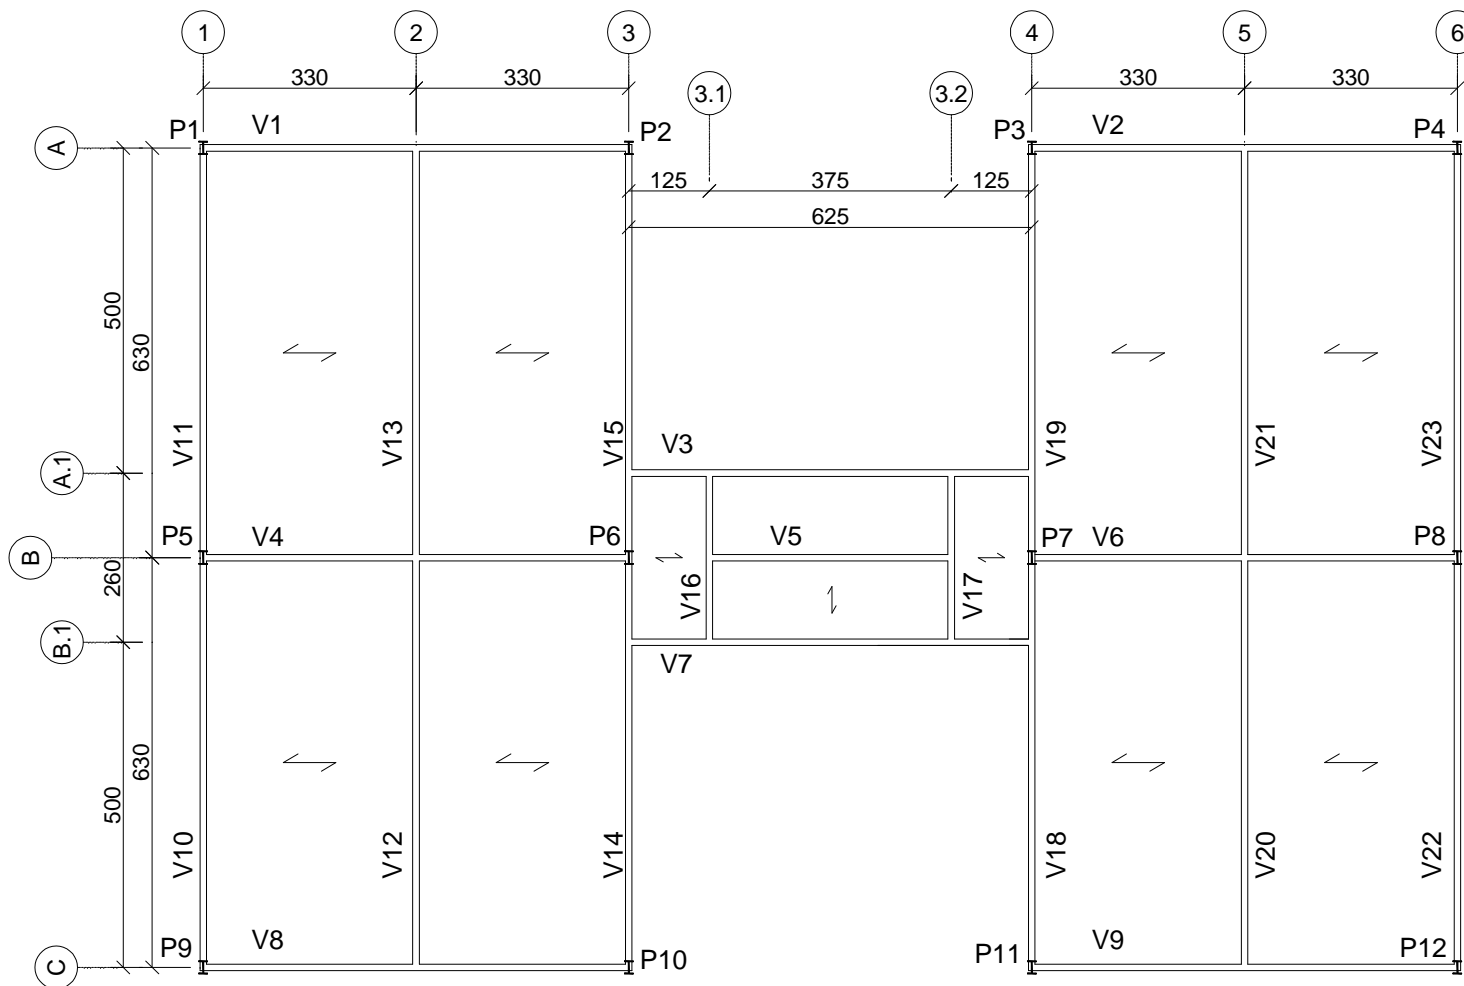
Disposição e numeração dos elementos estruturais e disposição do Steel-Deck para o edifício.
